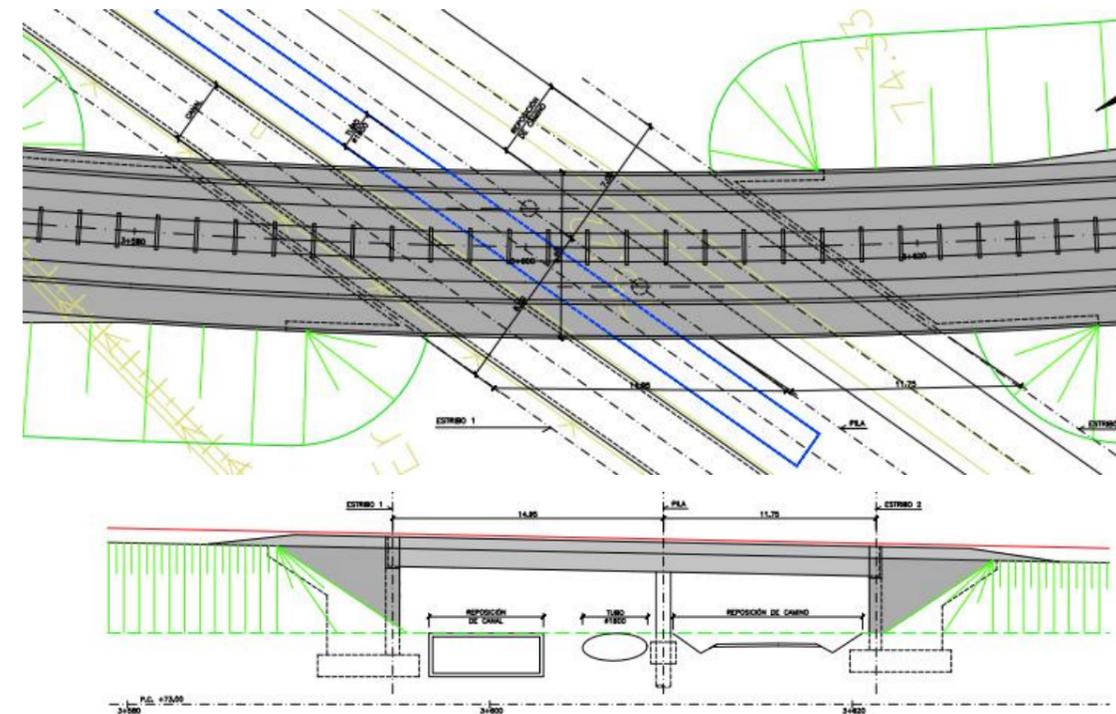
PLANTA Y ALZADO DEL PASO INFERIOR P.K. 3+600
